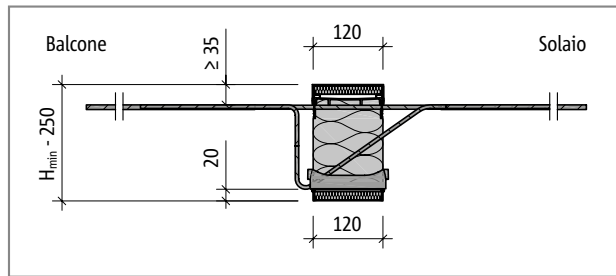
Schöck Isokorb® tipo da KXT15 a KXT40, REI120: sezione dell'elemento
